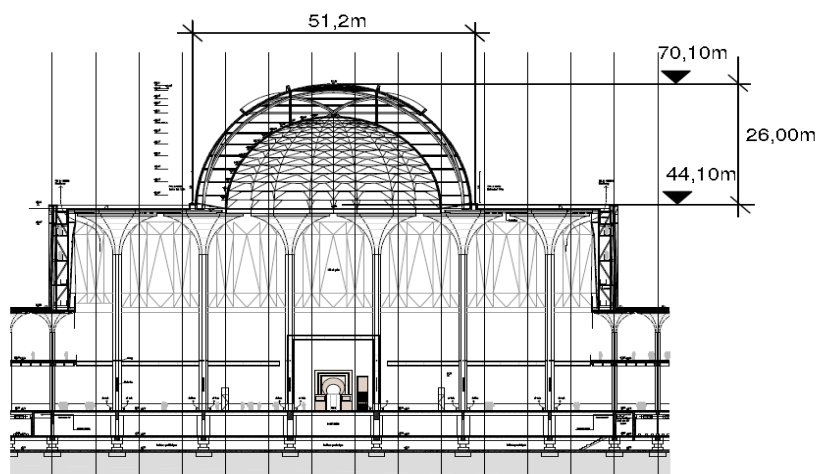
Coupe longitudinale de la salle de prière avec la structure de la coupole
